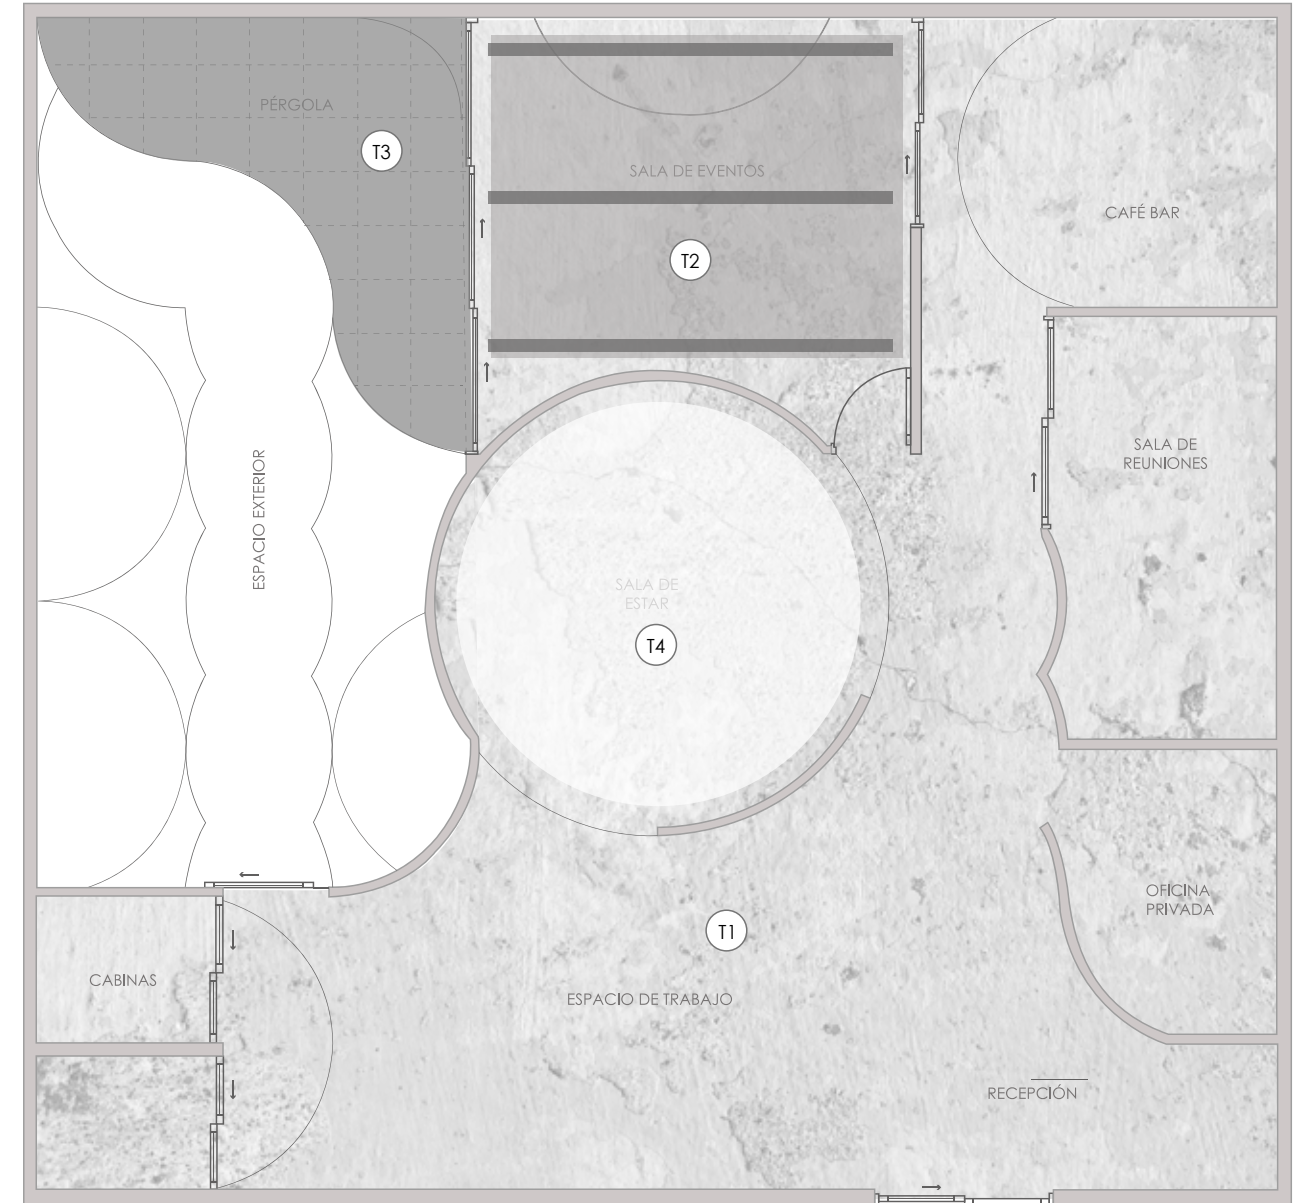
Plano Techos. Elaborado por Sharon Chavez.
